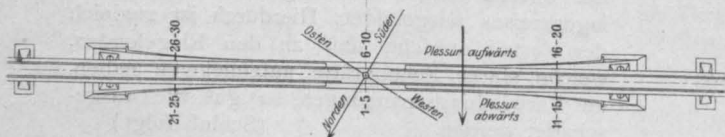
Grundriß mit den Himmelsrichtungen.
